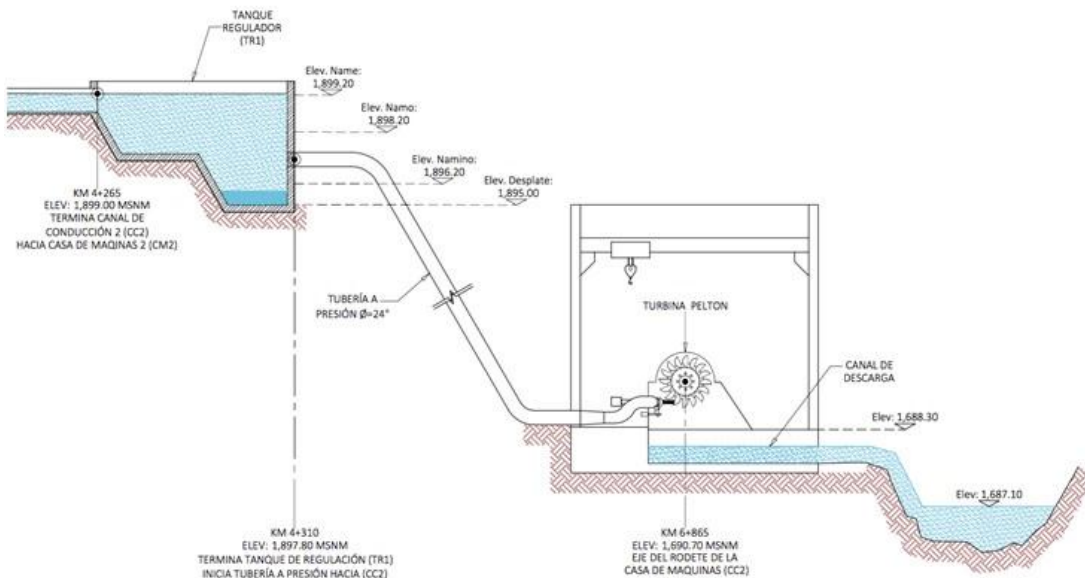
Perfil Tanque de Carga TC2 – Tubería a presión – CM2
